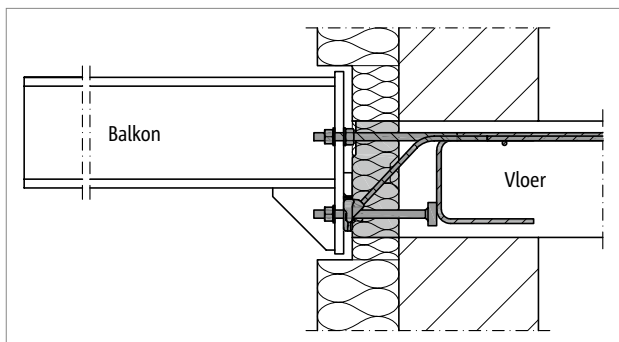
Schöck Isokorb® T type SK: Vrij uitkragend balkon
